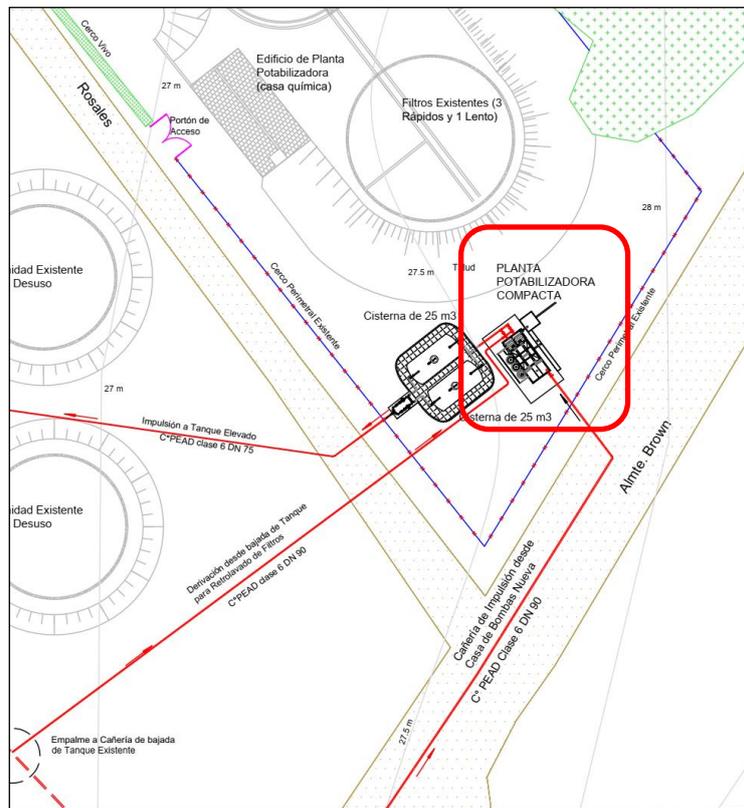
Ubicación de la Planta Potabilizadora compacta.
